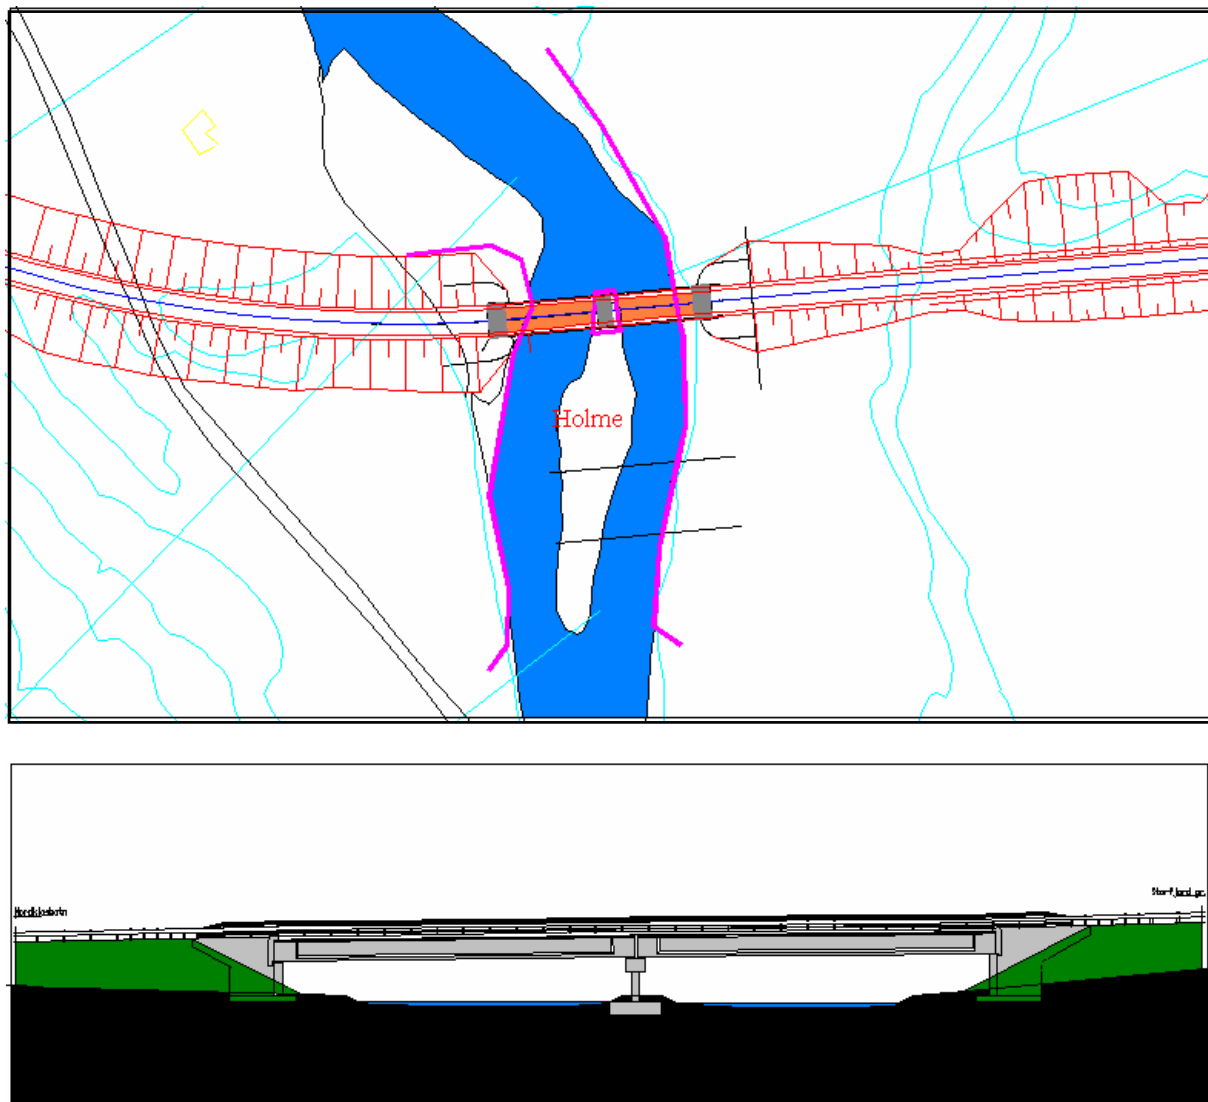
Brukryssing alt. 3 Heimly - bruplassering og utforming i plan og profil samt nødvendig erosjons sikring vist med lilla strek i plan
